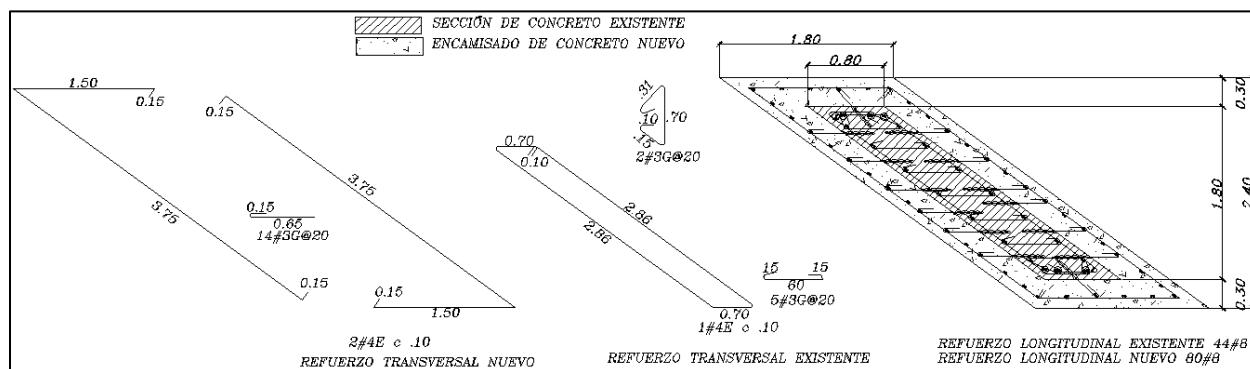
Propuesta reforzamiento columna pórtico de PRESA (elaboración propia)
